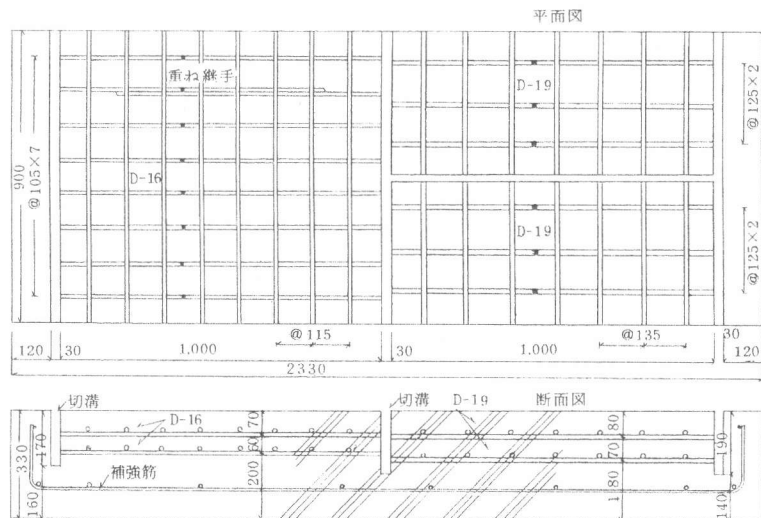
供試体形状・寸法・配筋図 (・印は熱電対設置箇所)
